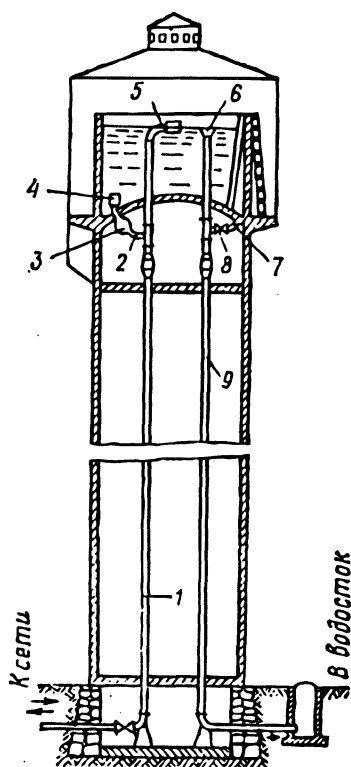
Схема оборудования водонапорной башни трубопроводами
